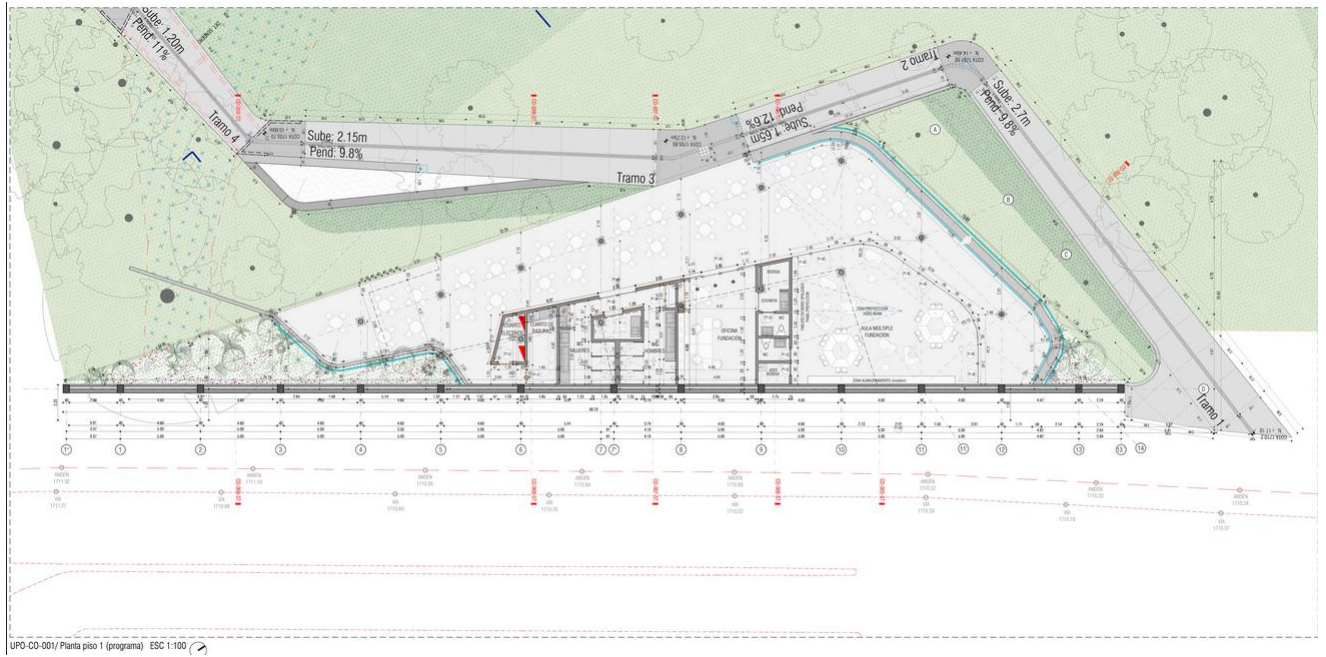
Planta Baixa do edifício administrativo. Fonte: site EPM.
